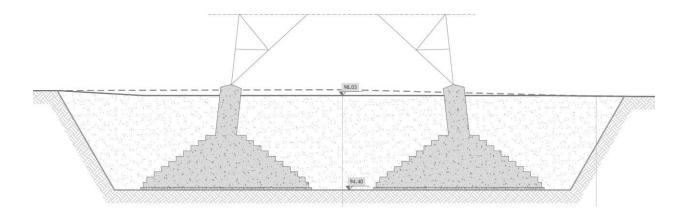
Schema tipo di fondazioni su plinti dei montanti dei tralicci metallici.
